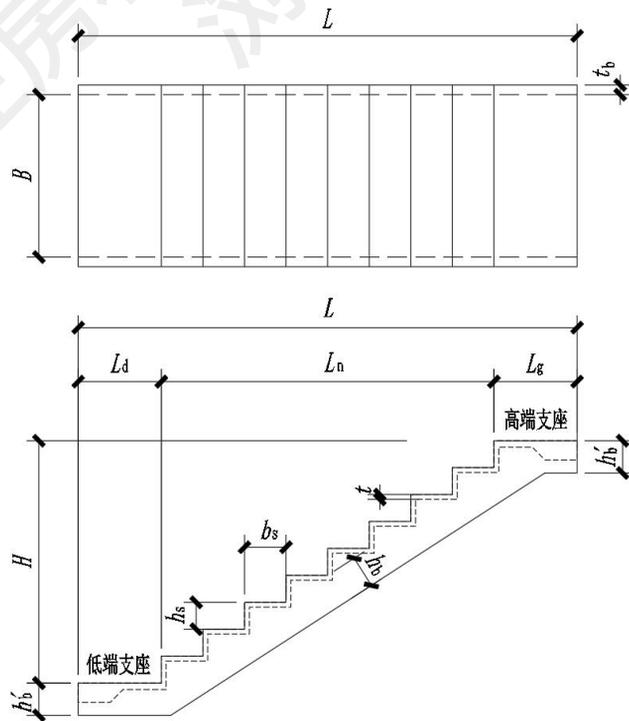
UHPC 预制楼梯平面、剖面示意图
